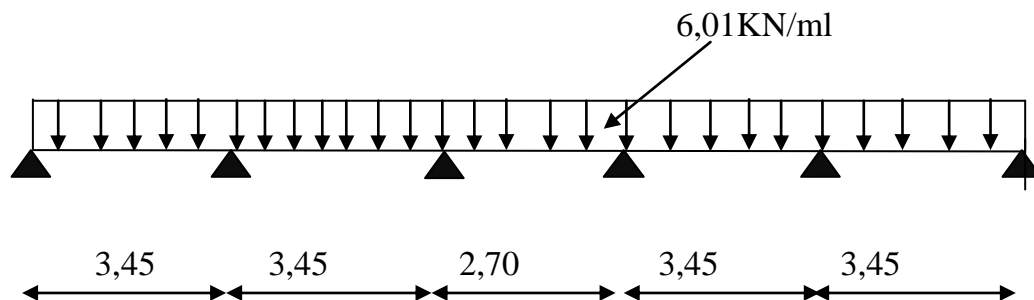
Schéma statique de la poutrelle à l'ELU
